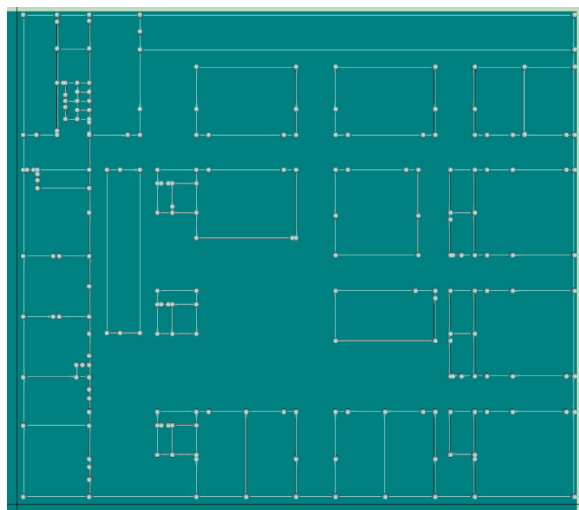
LIDER. Plantilla líneas auxiliares. Planta Sótano.
